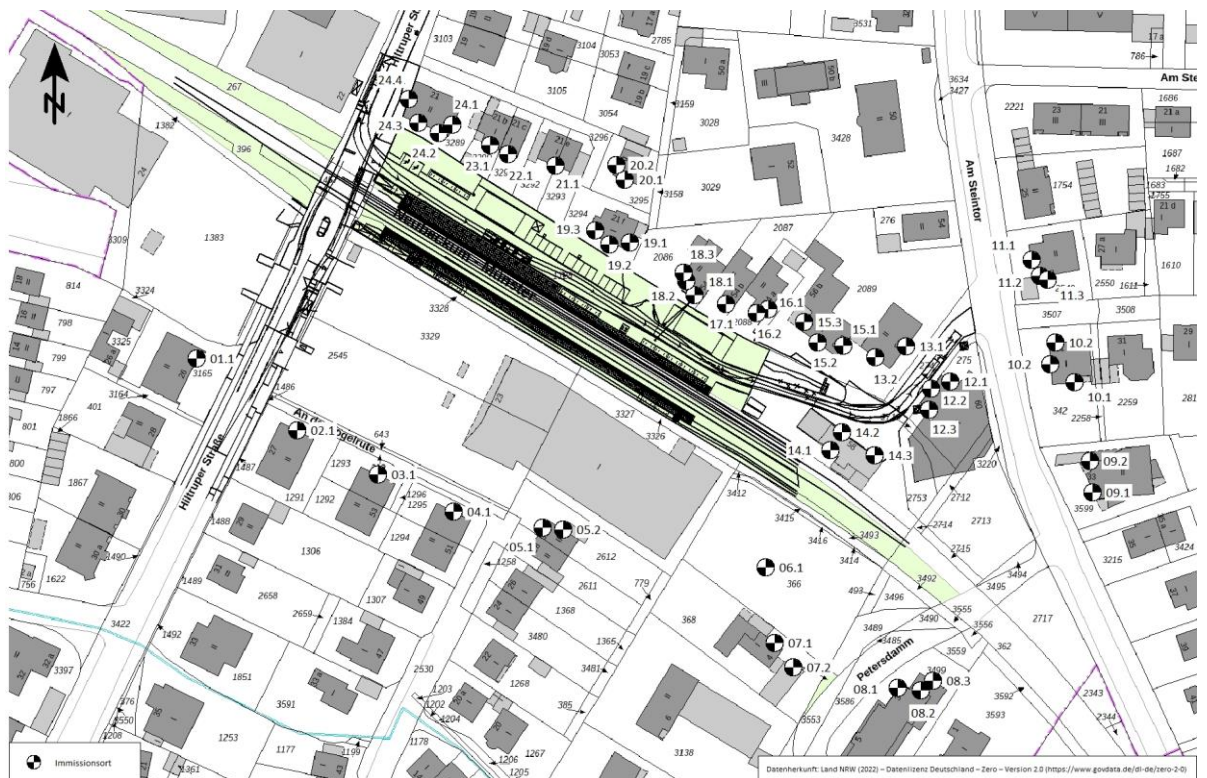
Übersichtslageplan mit Darstellung der betrachteten Immissionsorte
